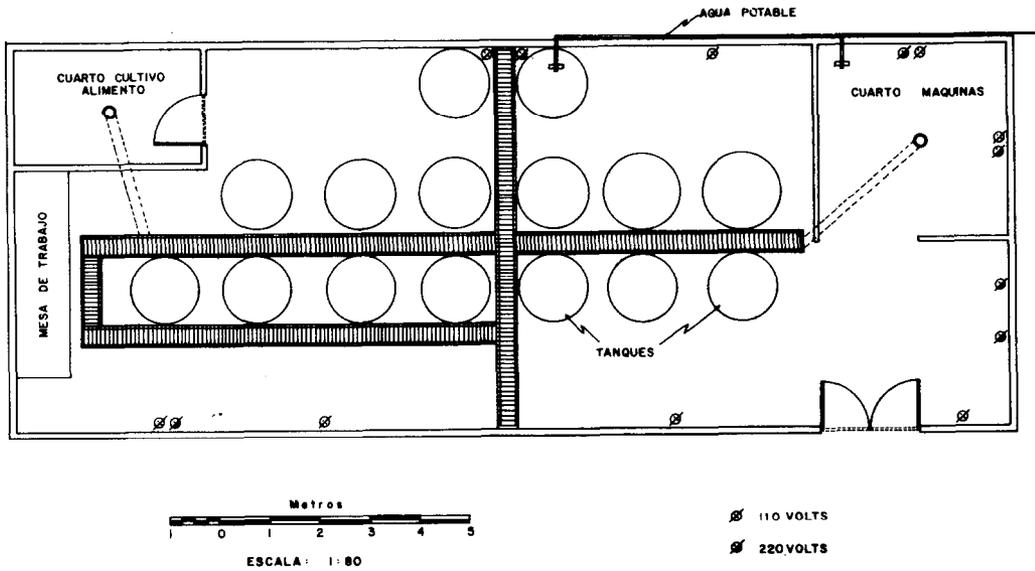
Diagrama de la planta de distribución del Laboratorio.
